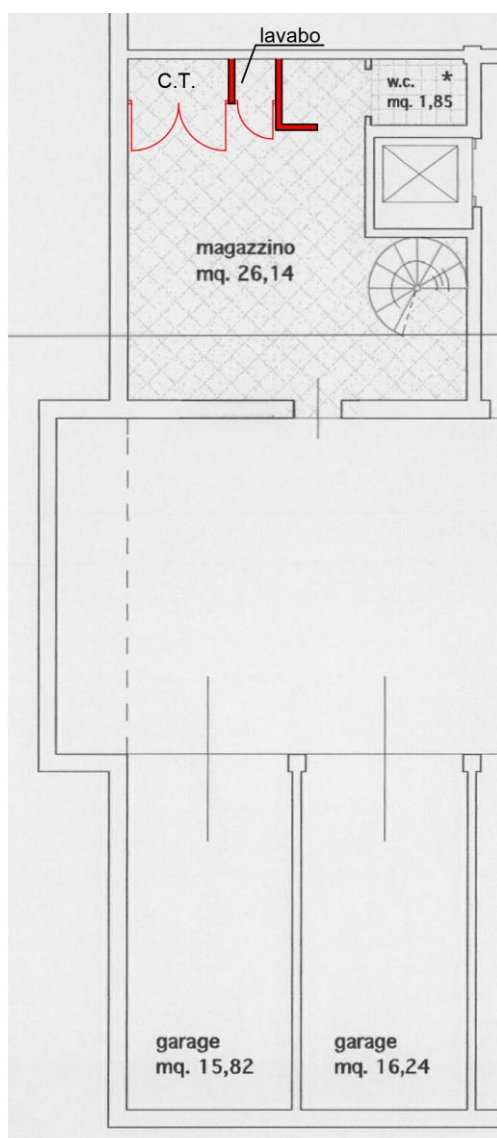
Pianta piano interrato, rilievo difformità riscontrate ([Allegato 13](#))
